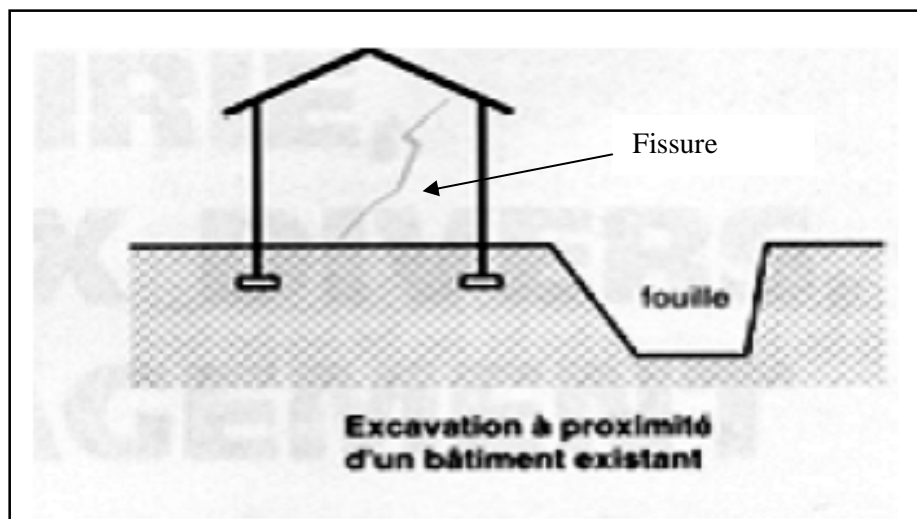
L'instabilité de sol : Cause de d'excavation et déblai. [12]
